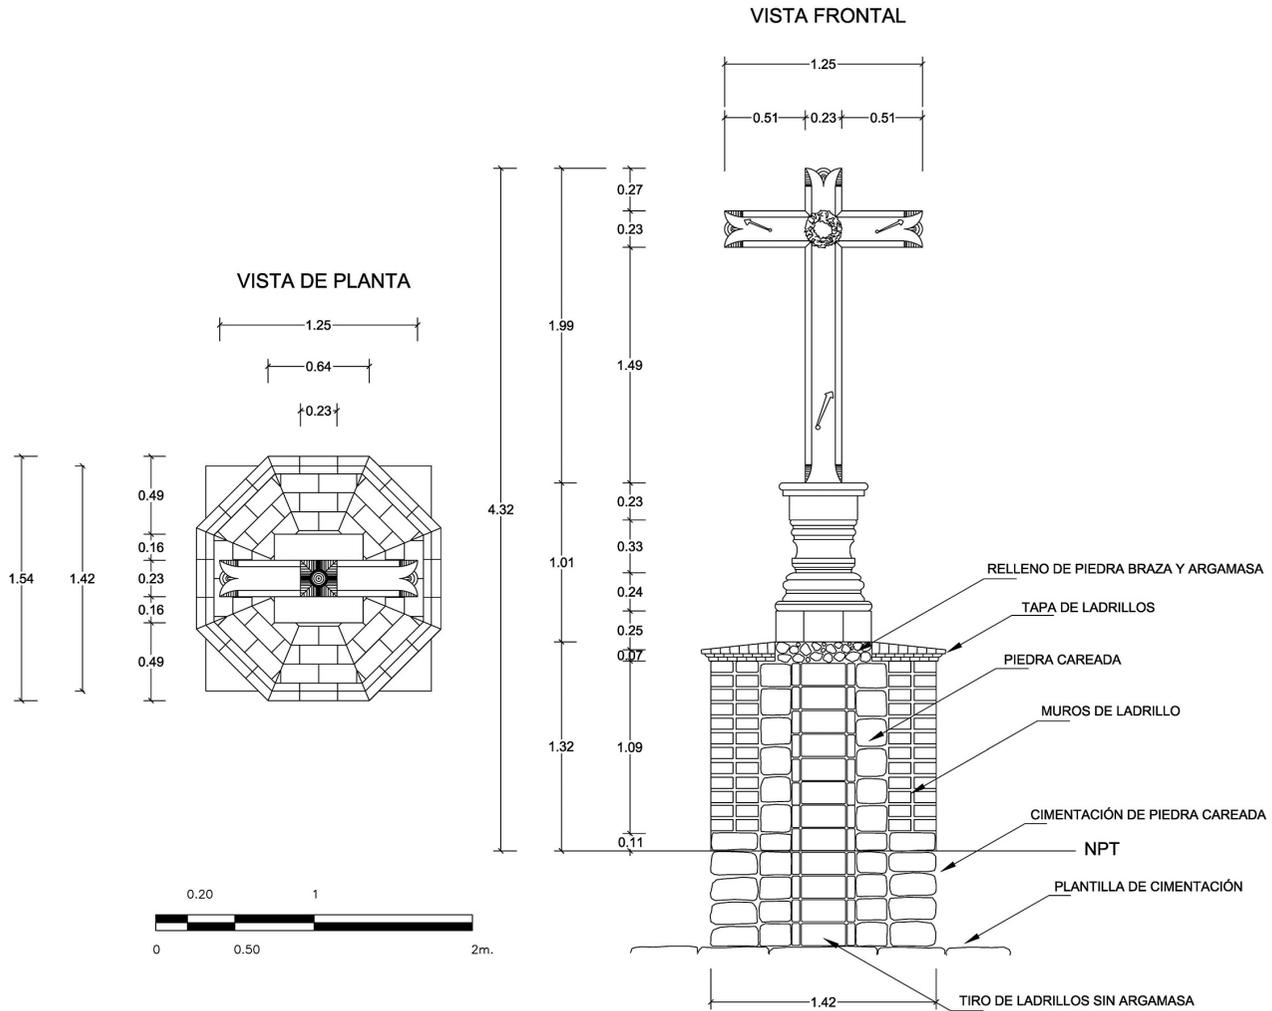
Planta y vista frontal de la cruz atrial de San Juan Bautista.
